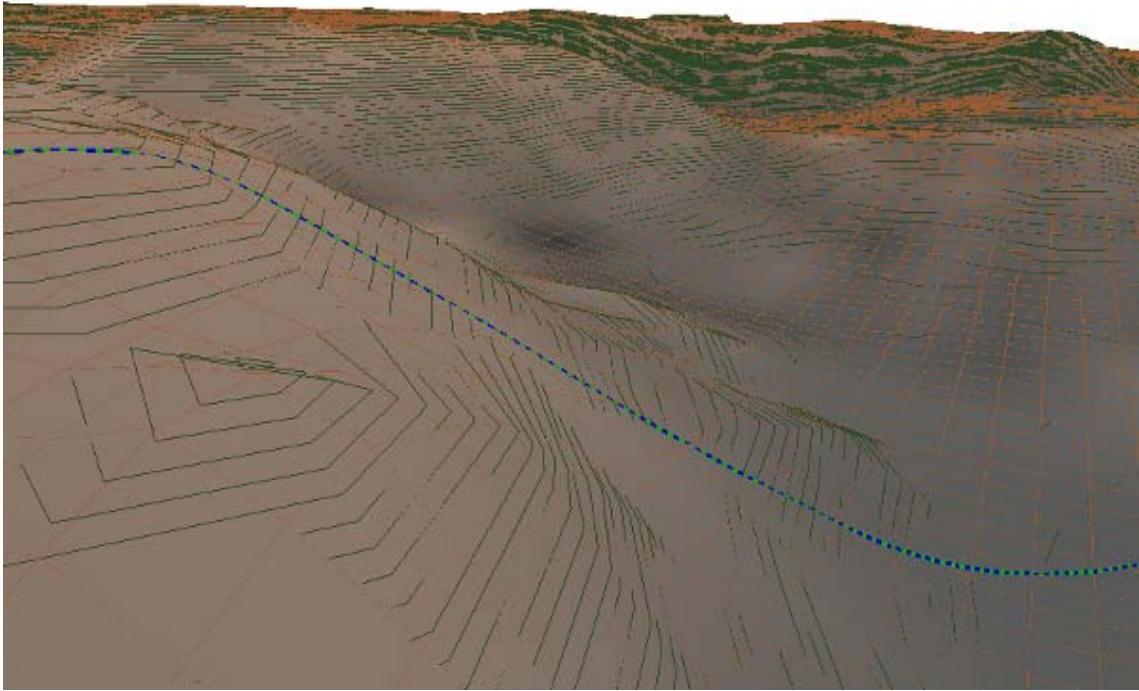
Configuração final apoiada – visão da descida do planalto – duto 8”
